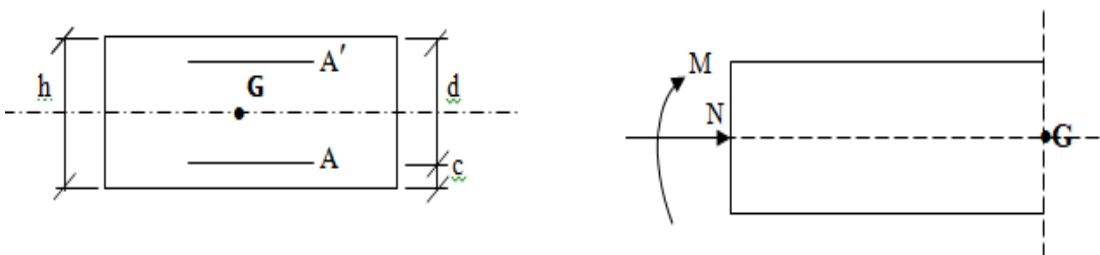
Dimension de la section à ferrailer d'acrotère
